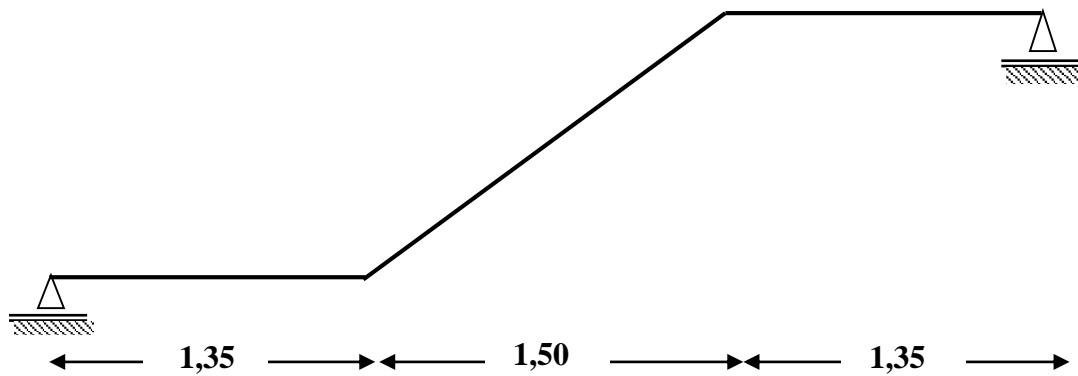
Schéma statique de la poutre brisée.
